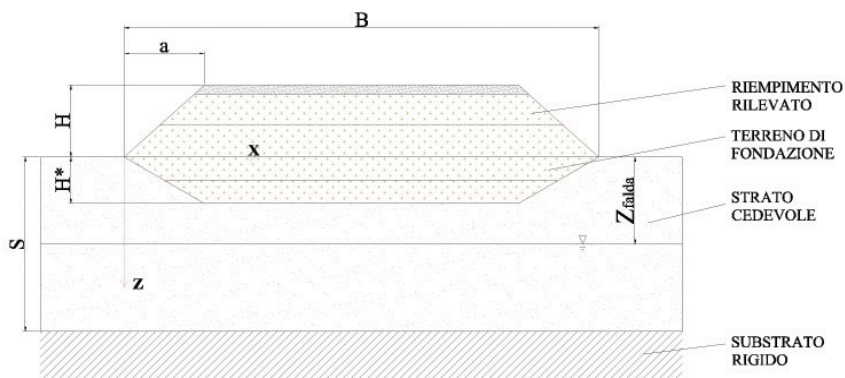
schema di un rilevato leggero con scavo parziale del terreno di fondazione.
